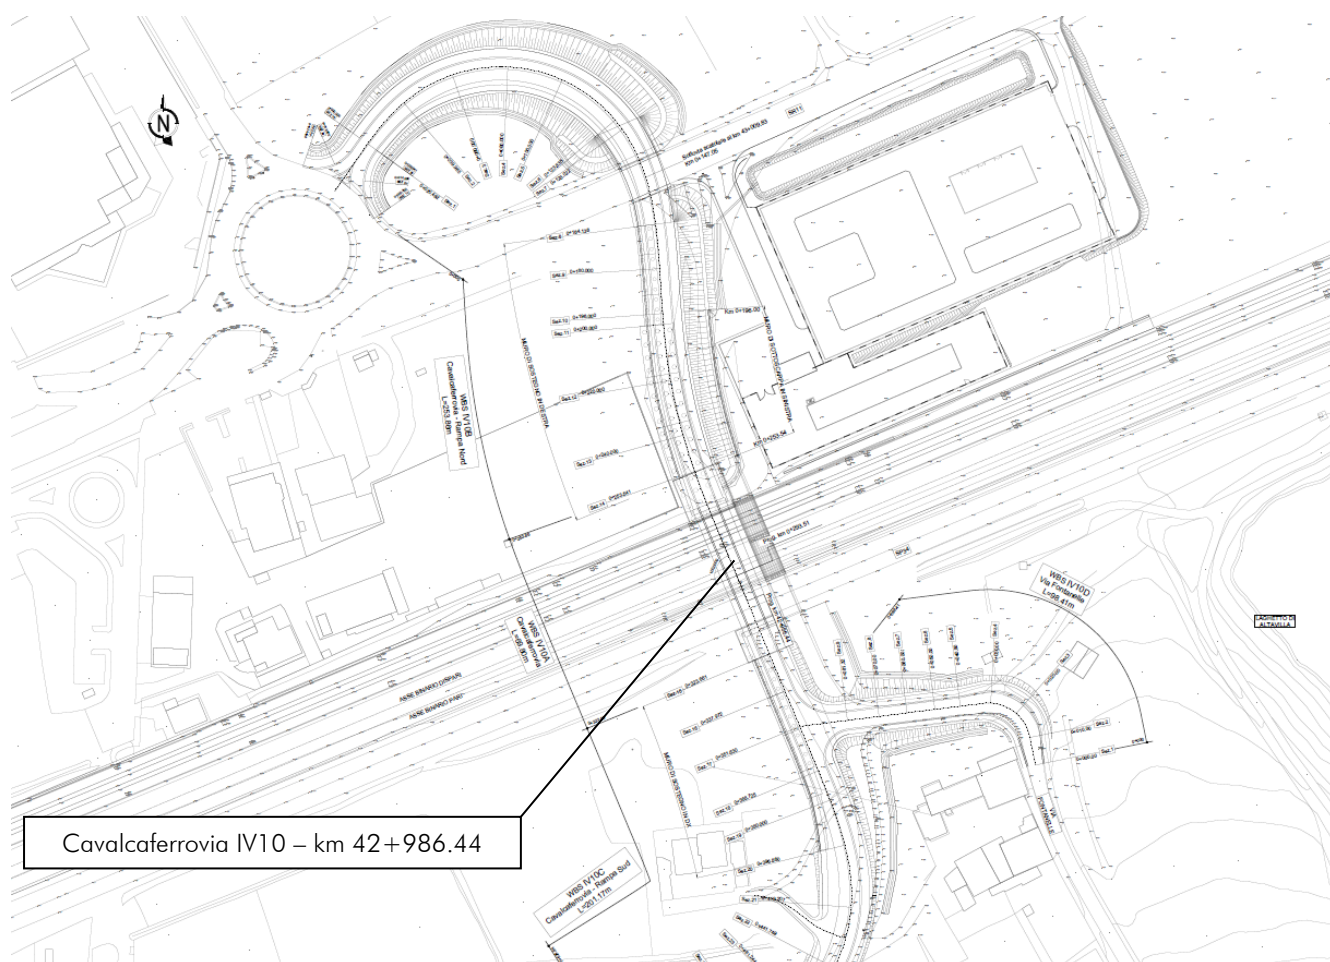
Stralcio planimetrico – Ubicazione Cavalcaferrovia IV10
